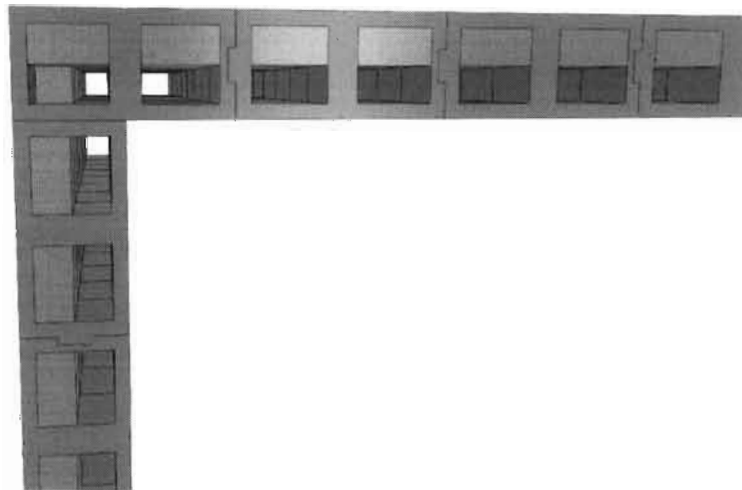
Vedere spațială a modului de țesere a blocurilor prefabricate și a suprapunerii golurilor verticale în scopul realizării continuității montanșilor din beton armat
